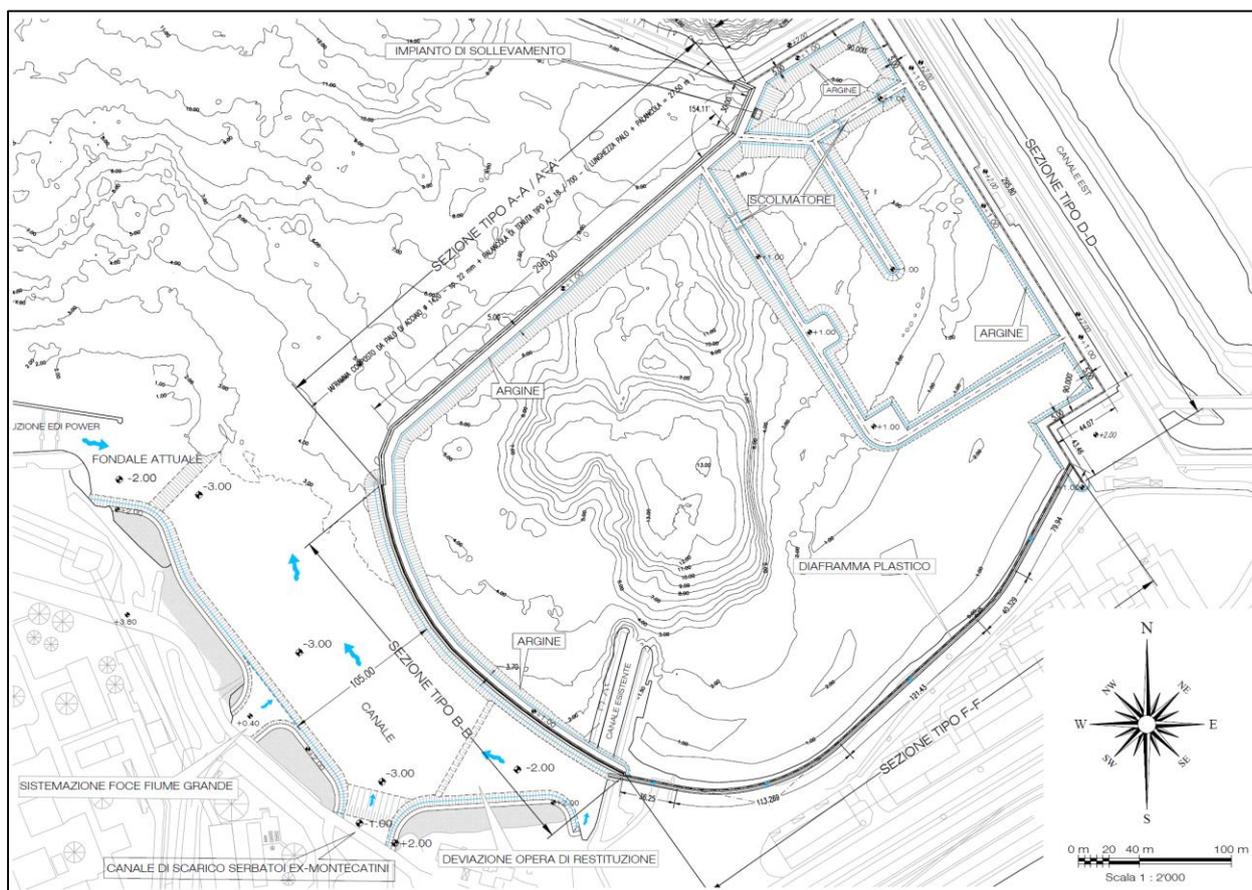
Scenario di progetto. Sistemazione idraulica degli sbocchi a mare.
